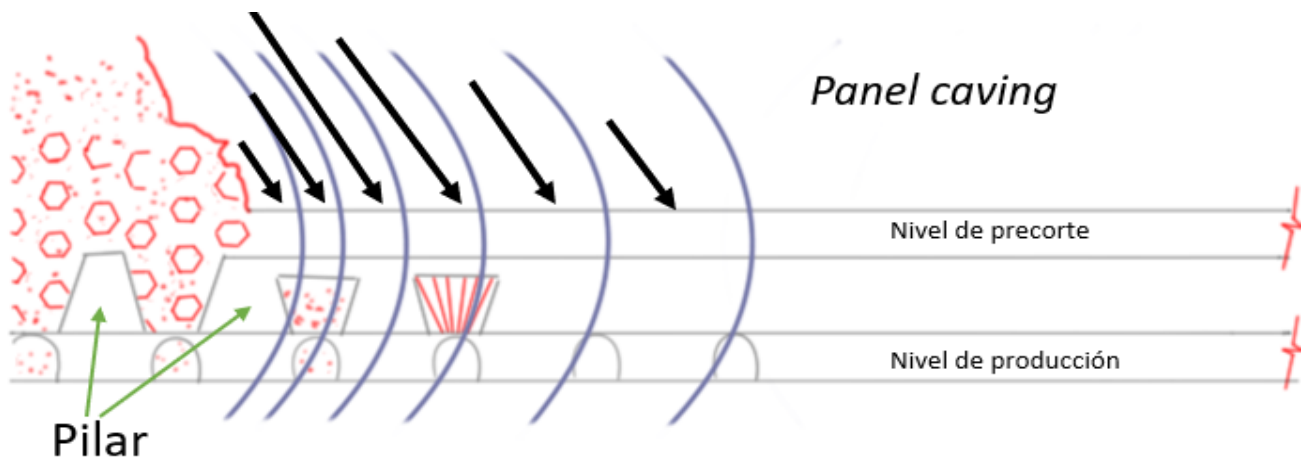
Redistribución de esfuerzos en panel caving (*stress abutment*) (Modificado de Barraza & Croknan 2000).
